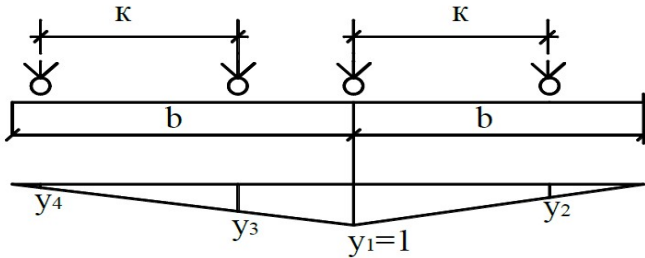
Схема определения вертикальной крановой нагрузки
